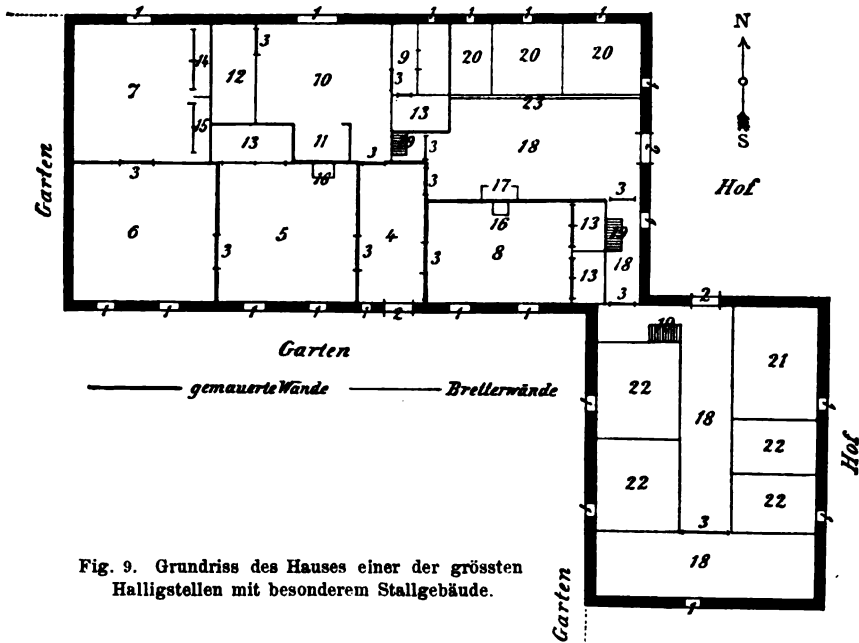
Grundriss des Hauses einer der grössten Halligstellen mit besonderem Stallgebäude.
